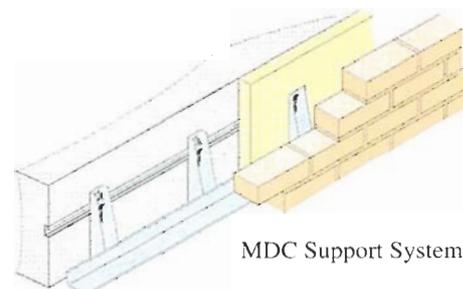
Axonométrica del apoyo de la hoja exterior sobre un perfil continuo de acero inoxidable, sistema Ancon.
